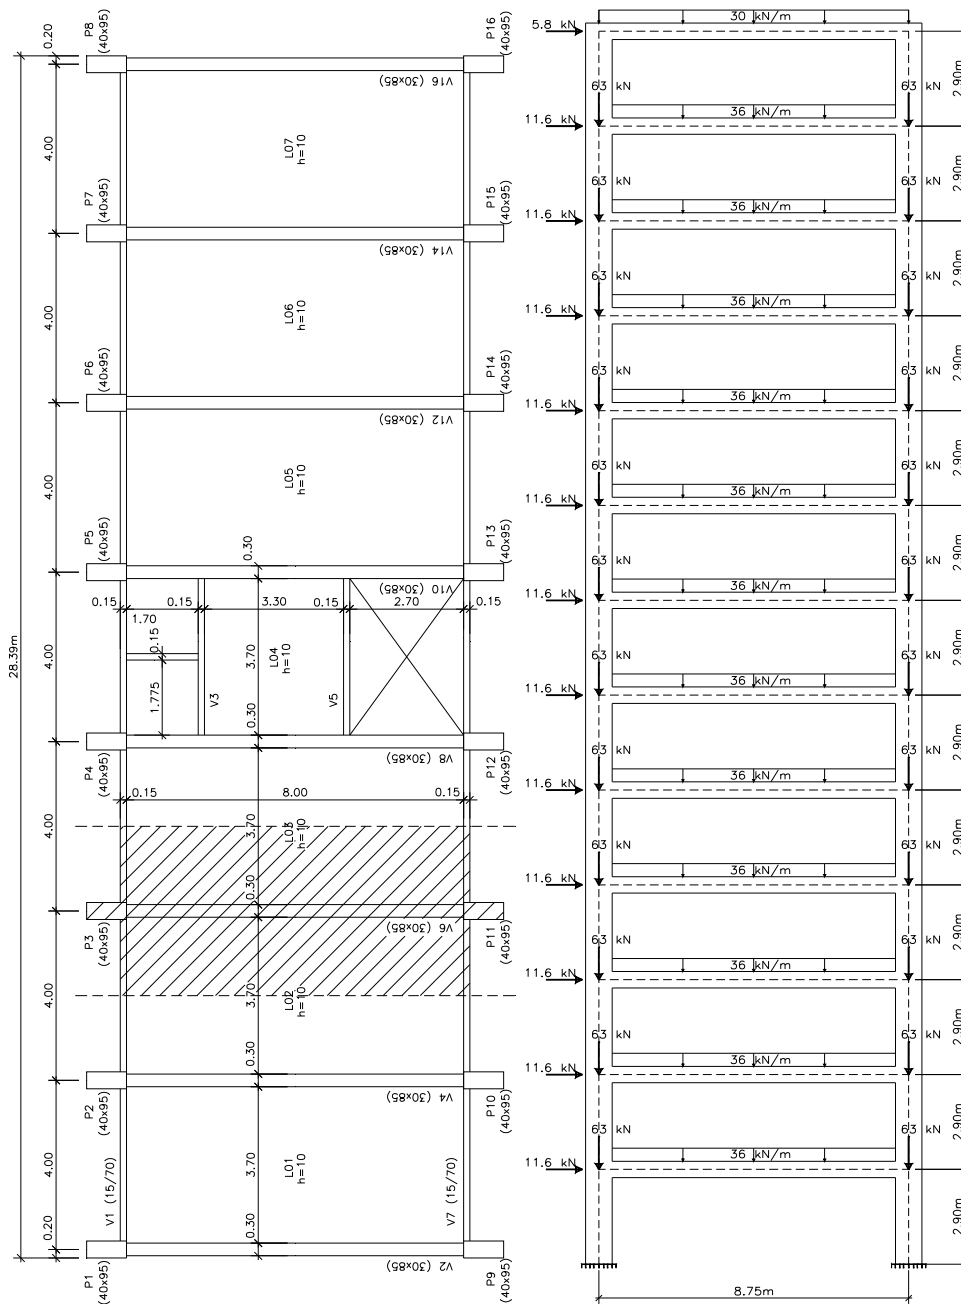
Geometria do edifício 13 pavimentos e do pórtico analisado
